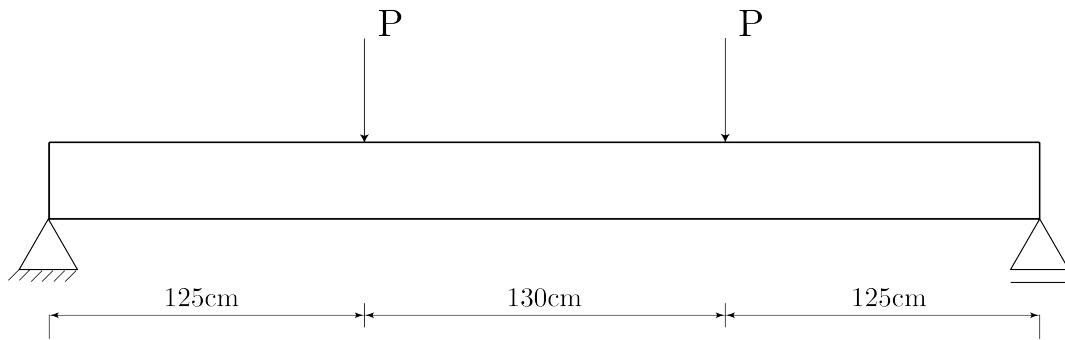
Viga bi apoiada e carregamento - Aplicação 2
